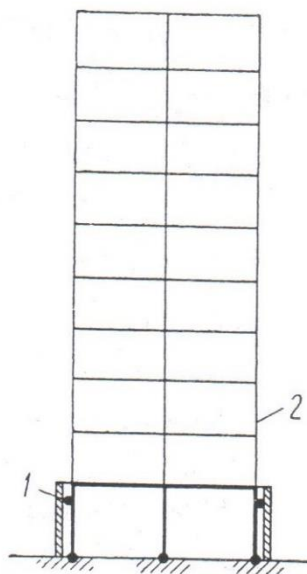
Схема крупнопанельного здания с гибким нижним этажом [1]:
